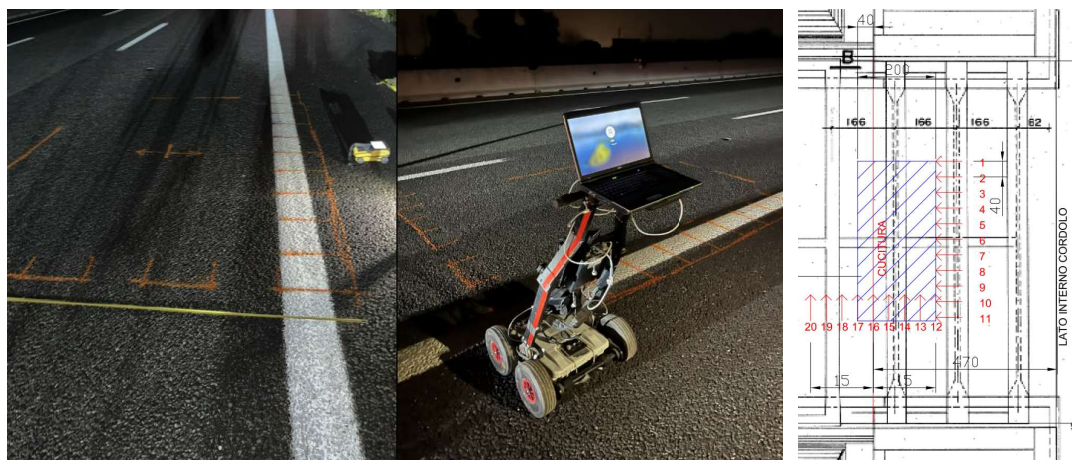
Determinazione spessore pavimentazione con georadar multicanale – griglia di acquisizione
